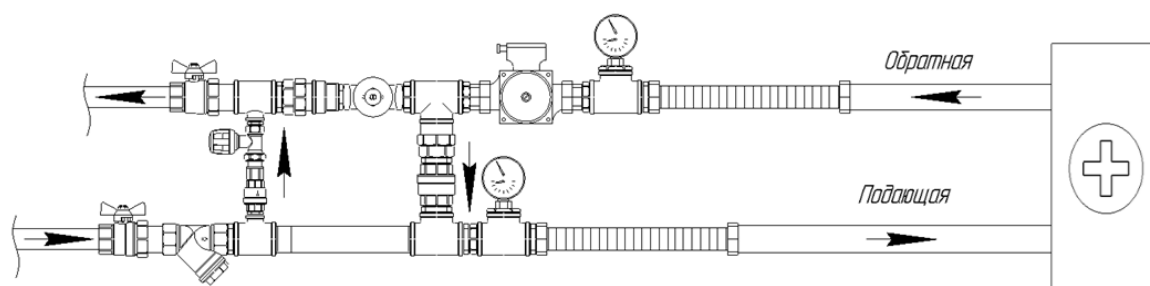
Смесительный узел СТАНДАРТ+ с двухходовым клапаном на резьбовом присоединении
